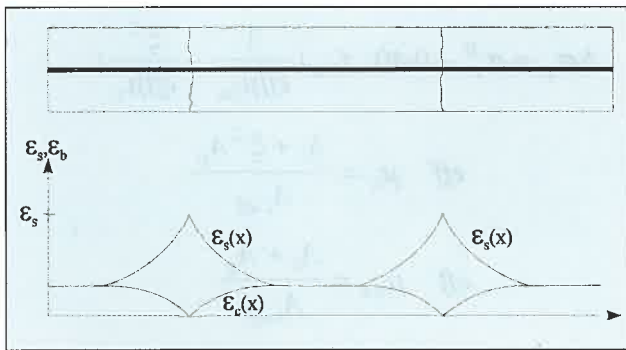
Dehnungsunterschied zwischen Stahl und Beton beim Einzelriß
